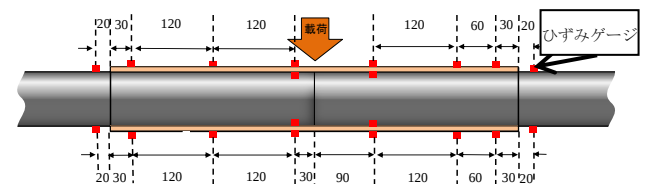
mf-300 一軸ひずみゲージ設置箇所(単位:mm)
